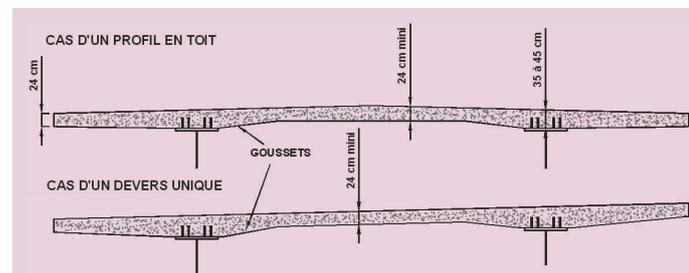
Principe de coffrage de la dalle d'un tablier sans pièce de pont
